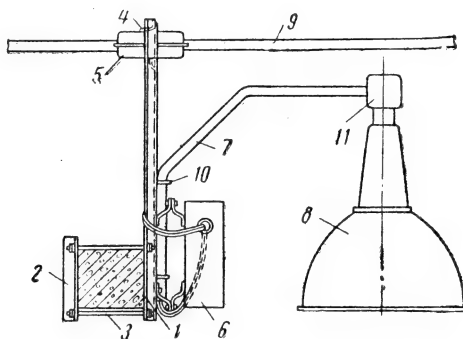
Крепление светильника и тросового провода к нижнему поясу железобетонной фермы.
